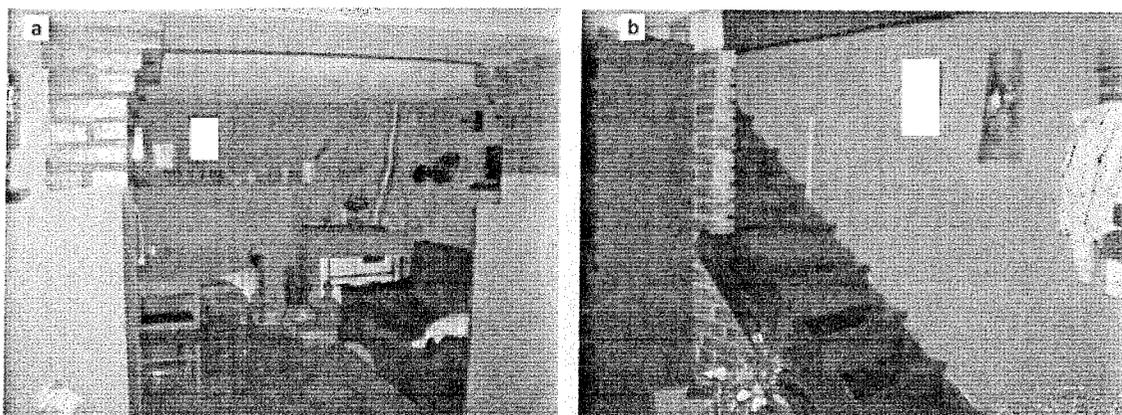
Piano terra. a) In evidenza cucina rustica; b) Scale interne di collegamento con il piano primo.
